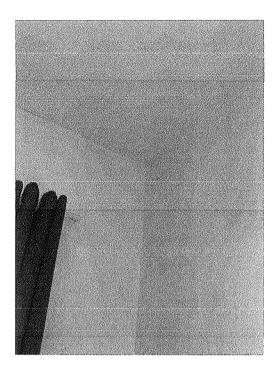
Infiltração ocasionando trincas na parede
